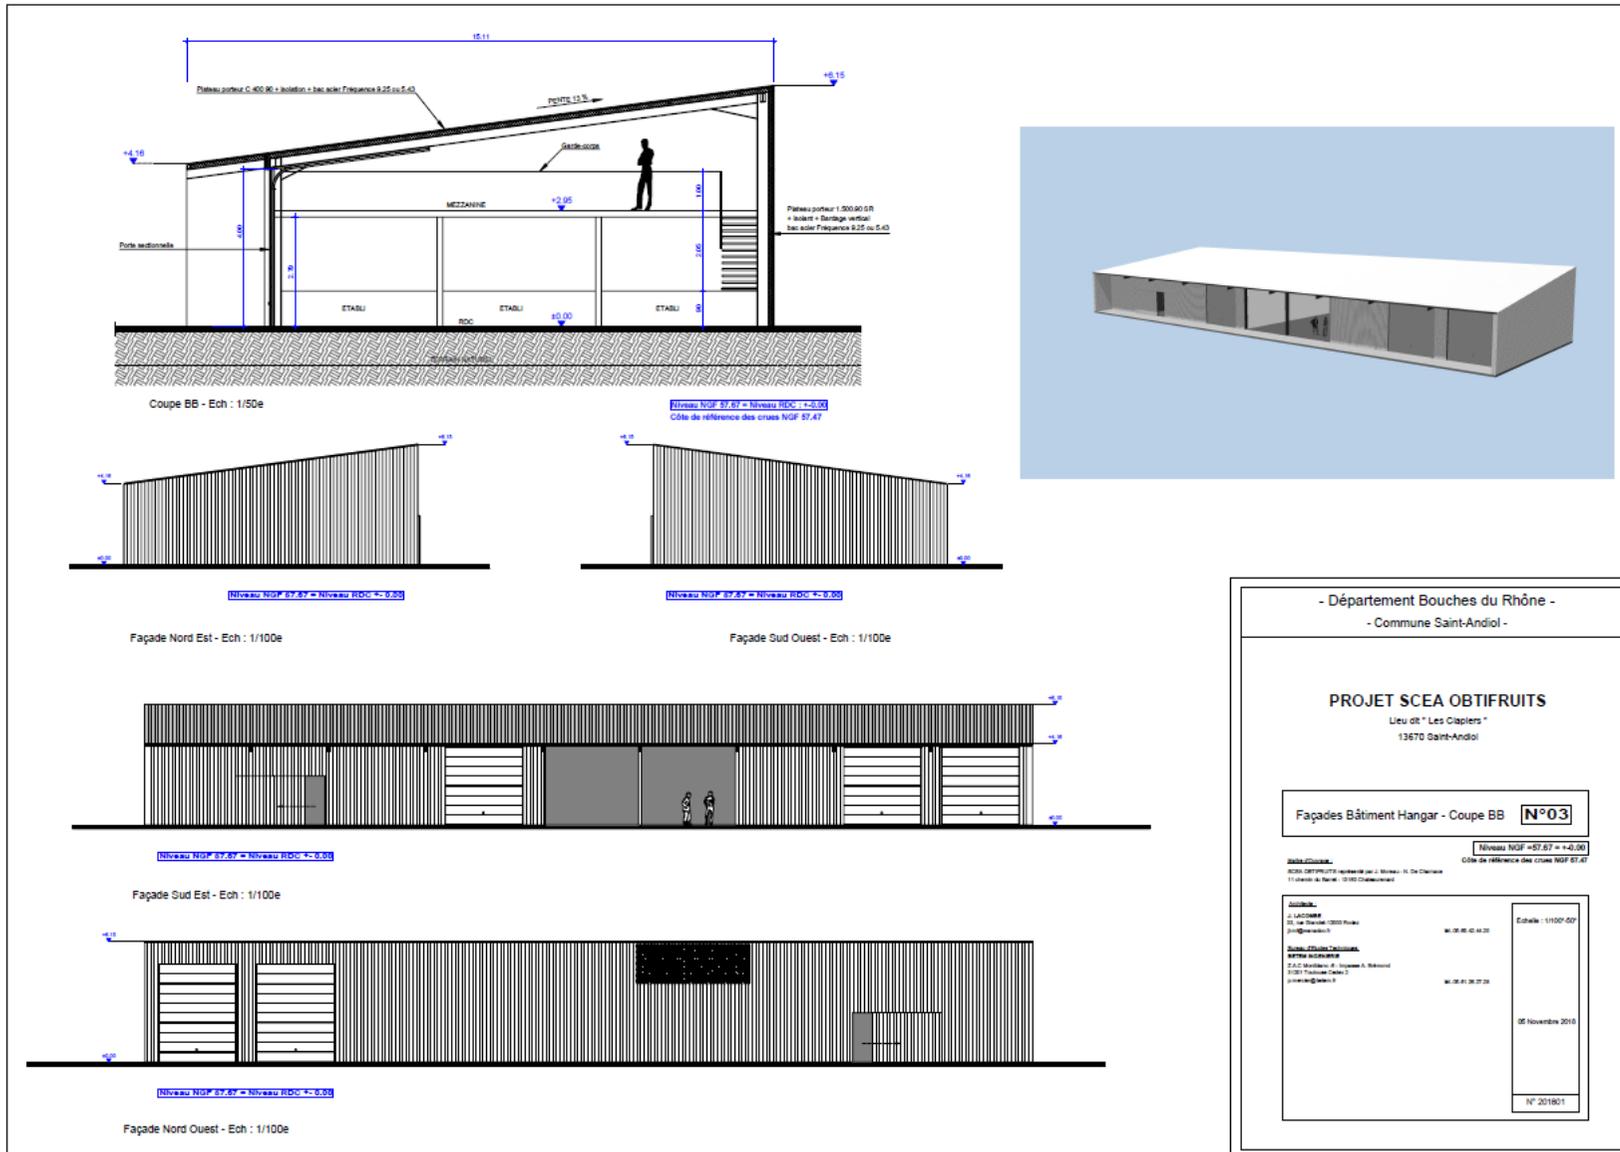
Façade du hangar – coupe BB (source : SCEA OBTIFRUILS, 05/11/2018)
